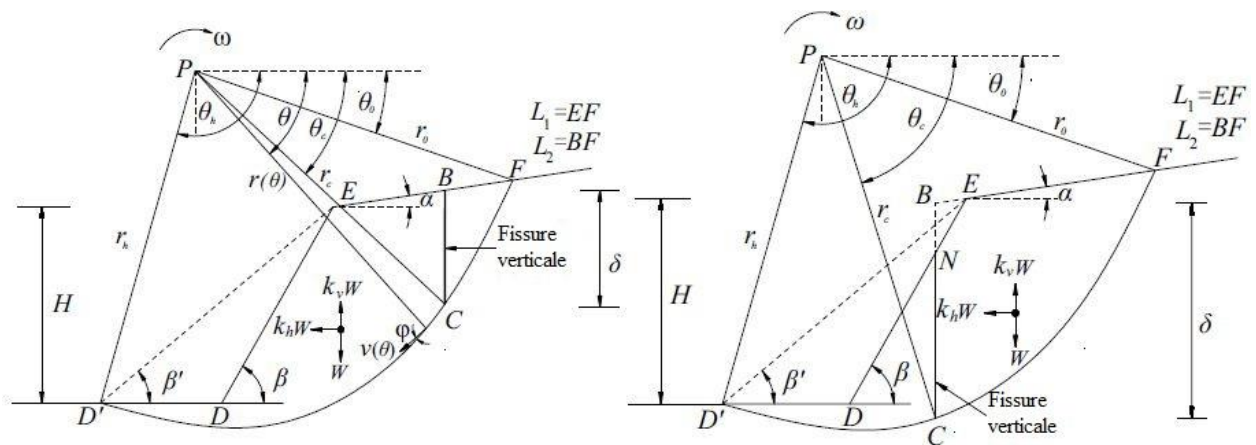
Mode de rupture d'une pente fissurée, à gauche fissures à travers la surface supérieure, et à droite fissures à travers la surface de la pente
